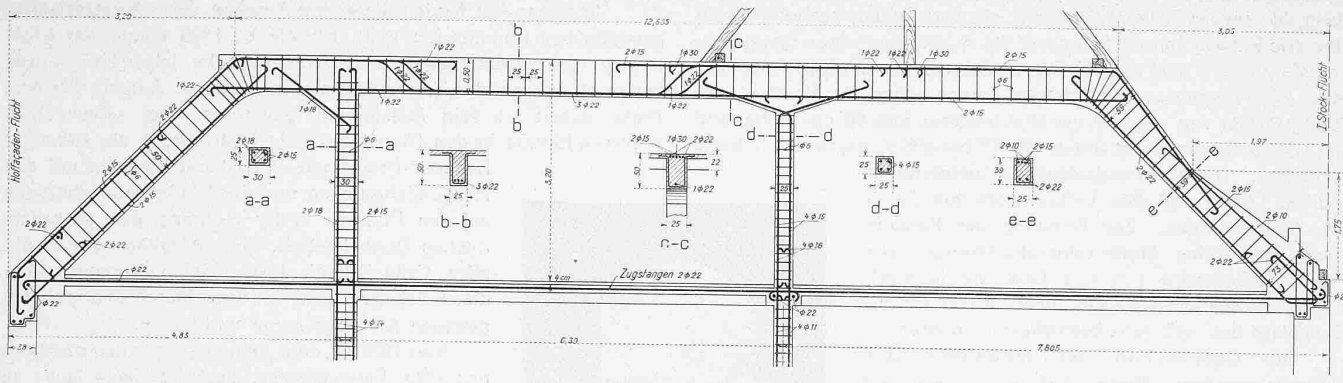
Armierungsplan des Dachbinders M. — Masstab 1 : 100.
